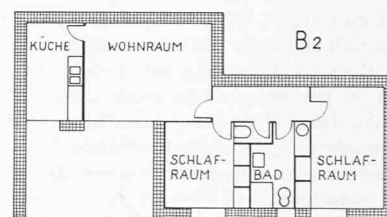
Grundriss 1:300 eines Dreizimmerhauses Typ B2 «Les Fourches»
